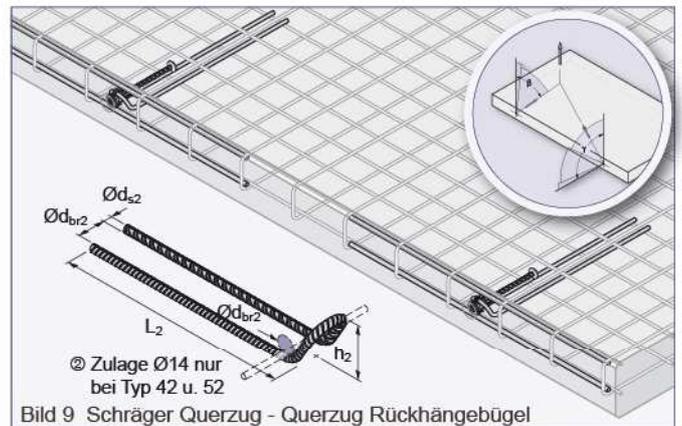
Schräger Querkzug - Querkzug Rückhängebügel
